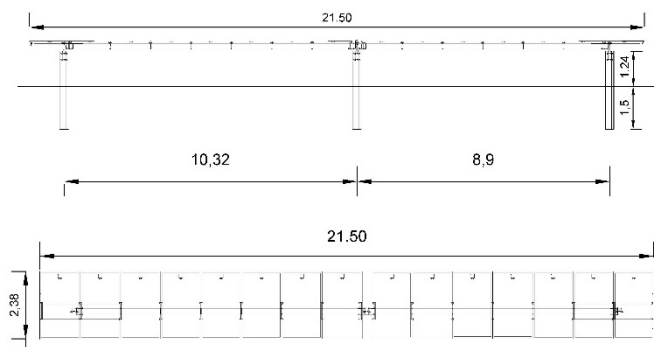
Prospetto frontale e vista in pianta delle strutture (15 moduli) ad inclinazione 0°
